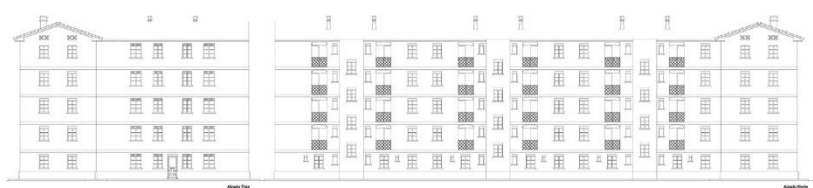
Alzado Este- Alzado Norte- Estado original
